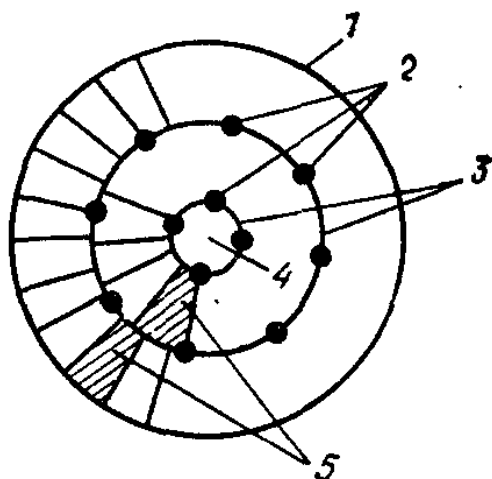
Схема сборного покрытия цилиндрического резервуара
